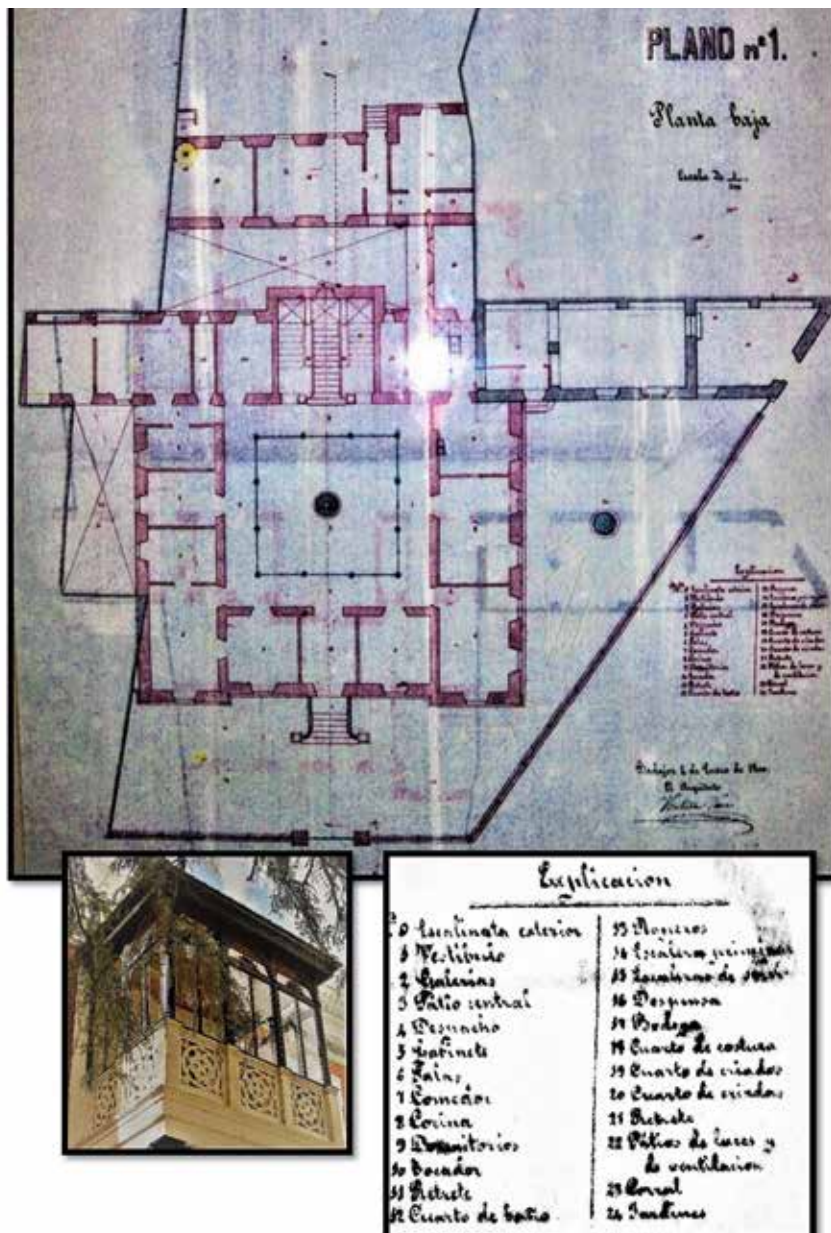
a 663. Plano de la planta baja. Mirador. Fuente: AMLI.
